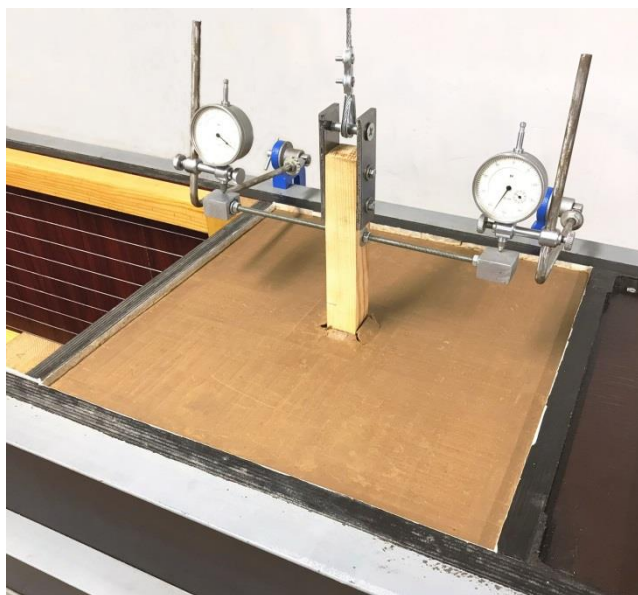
Срыв модели сваи в испытаниях на вертикальную нагрузку
